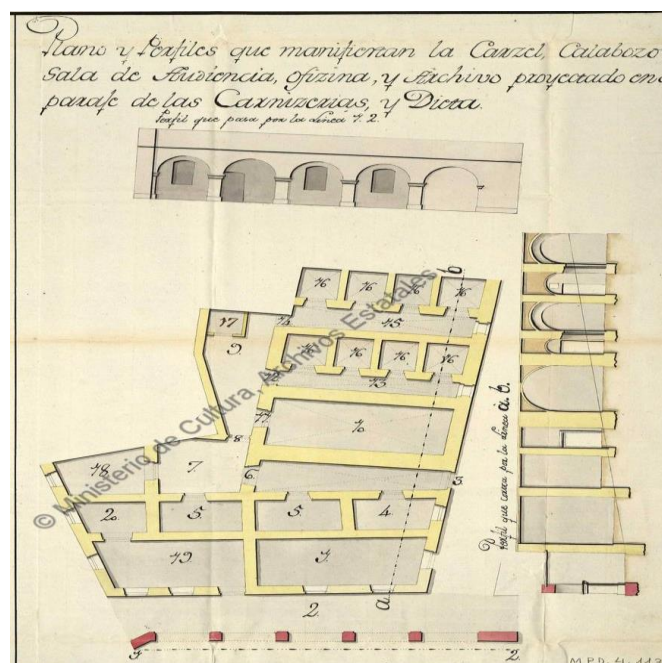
planos y elevación de un conjunto de edificios y los soportales de la Plaza.
